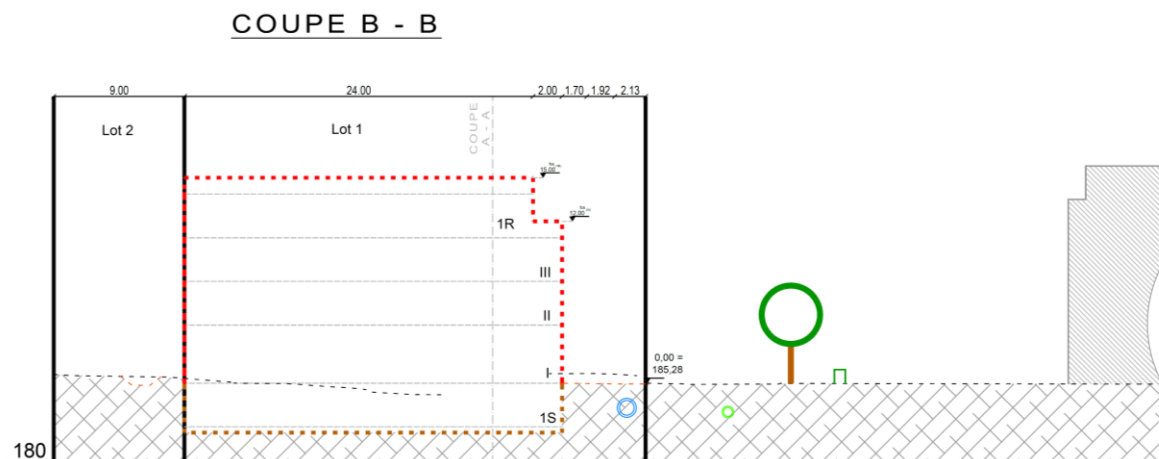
Coupe B-B du PAP. (Source : BEST)
